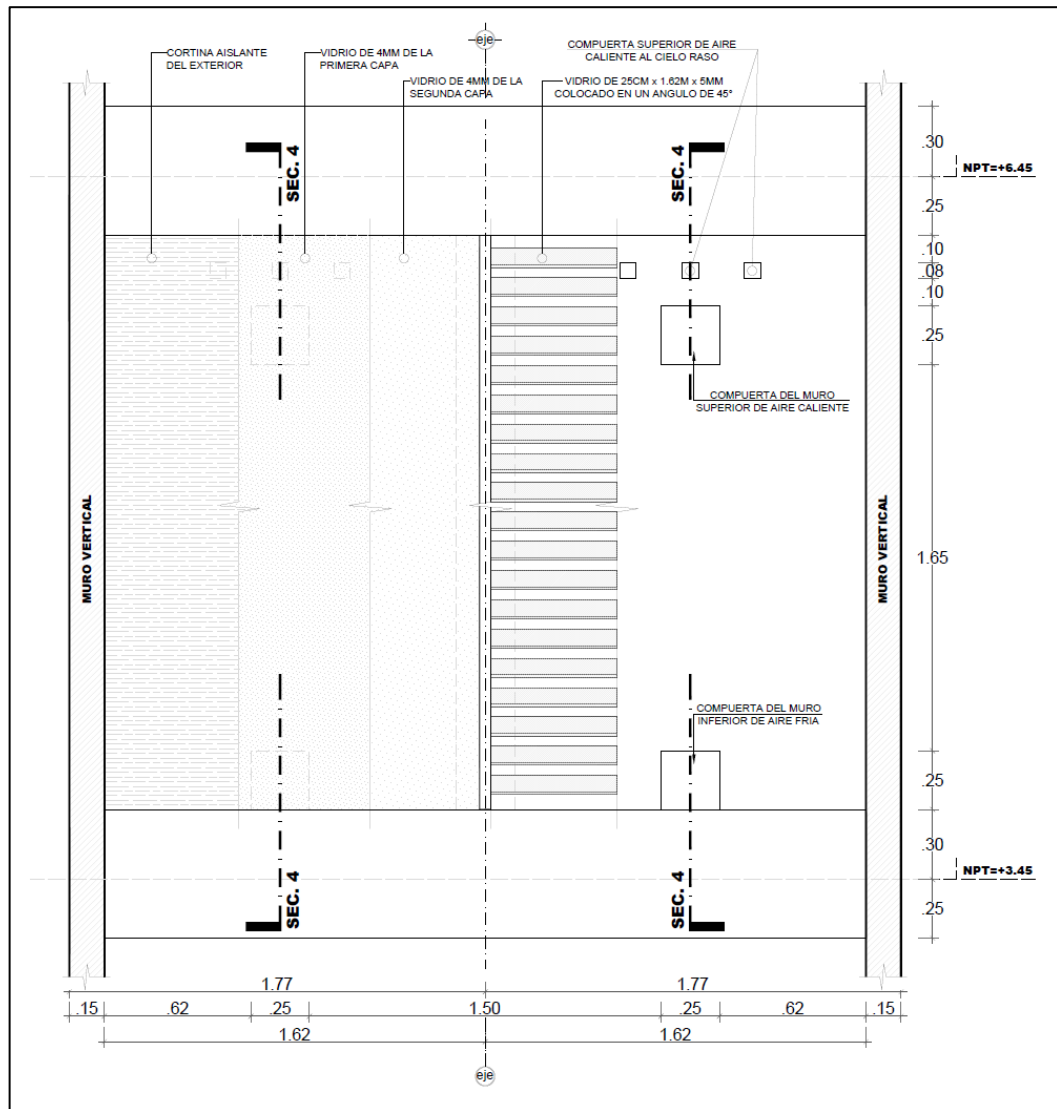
Fachada del sistema envolvente térmico muro trombe.
